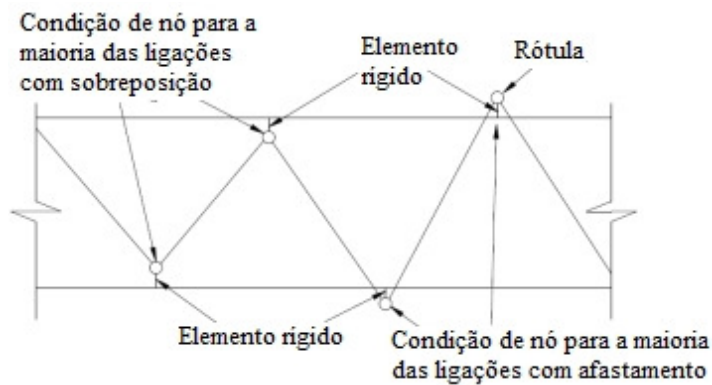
Modelo em pórtico plano proposto para análise por Packer (2009)
